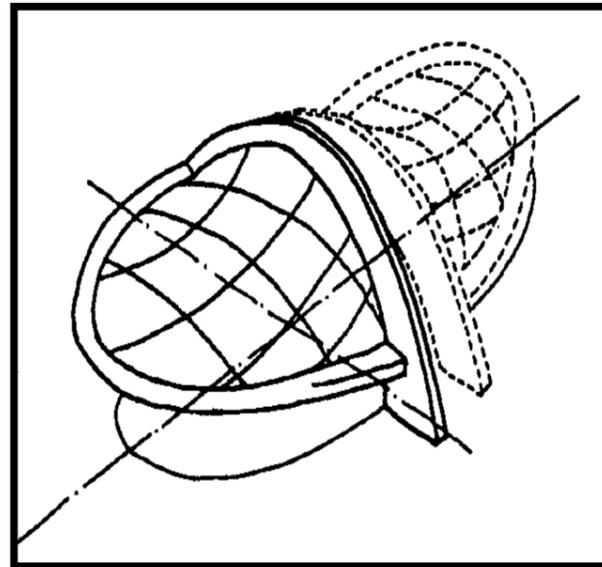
Anillo perimetral y pódicos de apoyo, Coliseo
